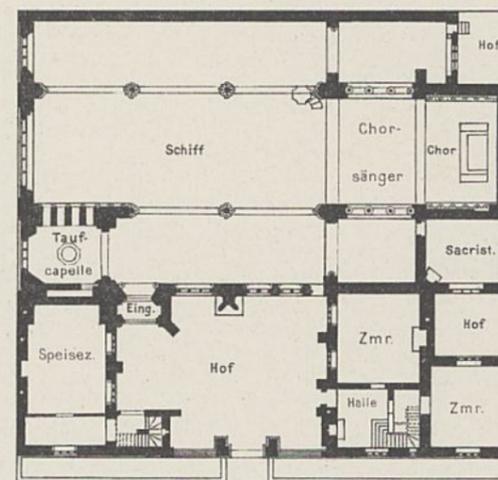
Allerheiligenkirche in Margaret Street London. Architekt Butterfield.
